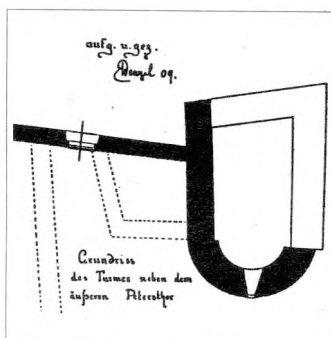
Grundriss des Turmes neben dem äußeren Peterstor.
